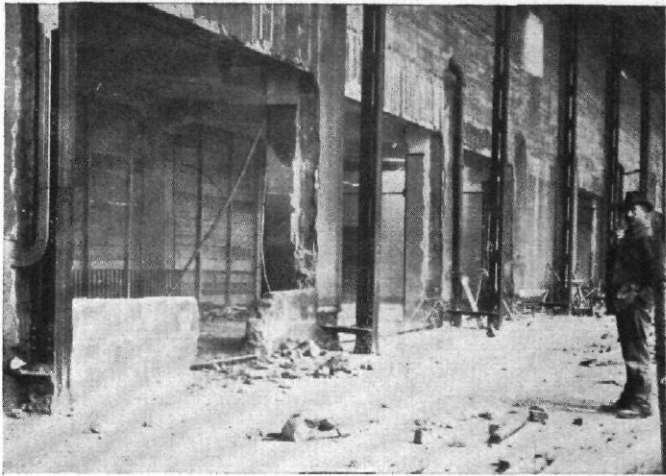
| Köln. Maskierung der Messehallen. Vor der alten Fassade stehen die modernen Eisenstiele der neuen Fassade, die dann mittelalterlich eingekleidet werden (vgl. Abb. 5)
